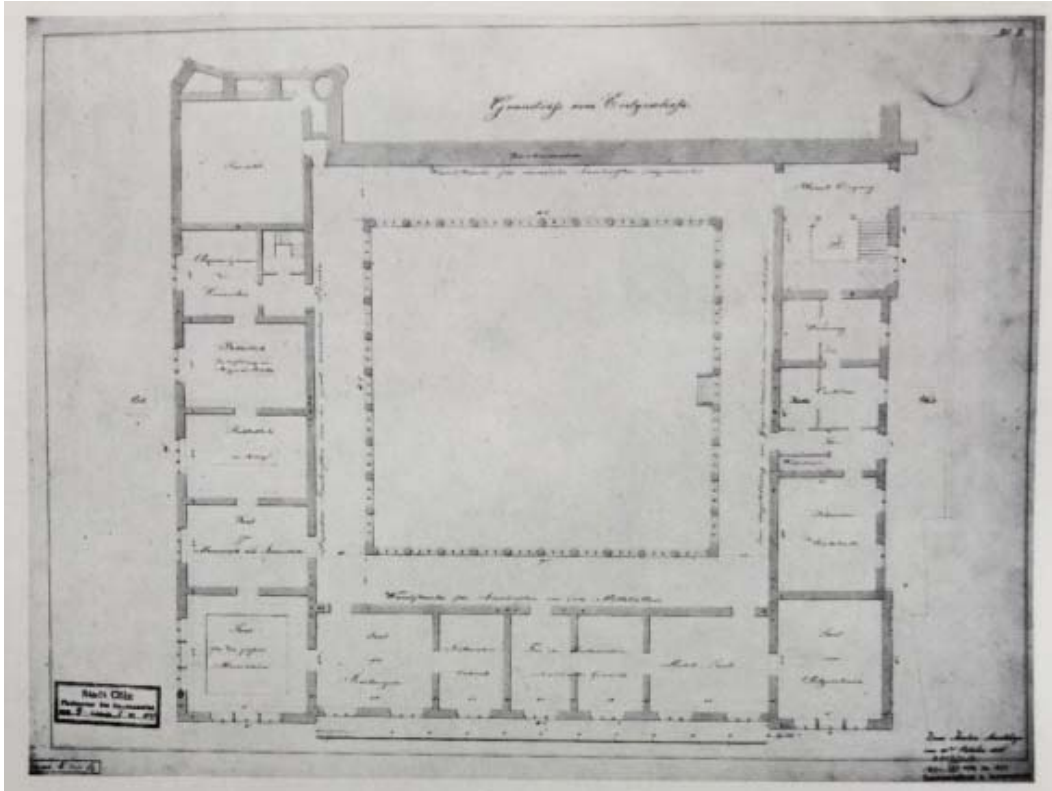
Ernst Zwirner – Entwurf für das Wallraf-Richartz-Museum – Grundriss
